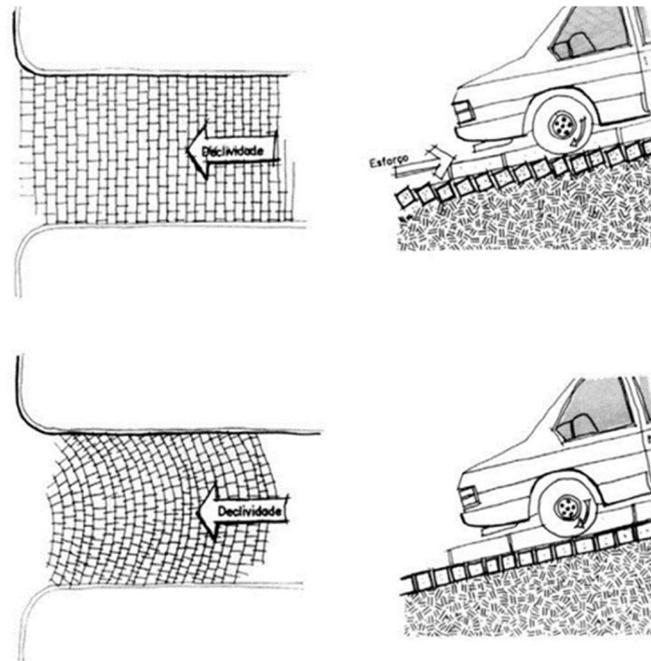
Pavimento de paralelepípedos ou blocos sem articulação colocados em arco, ideal para ruas em aclive.
